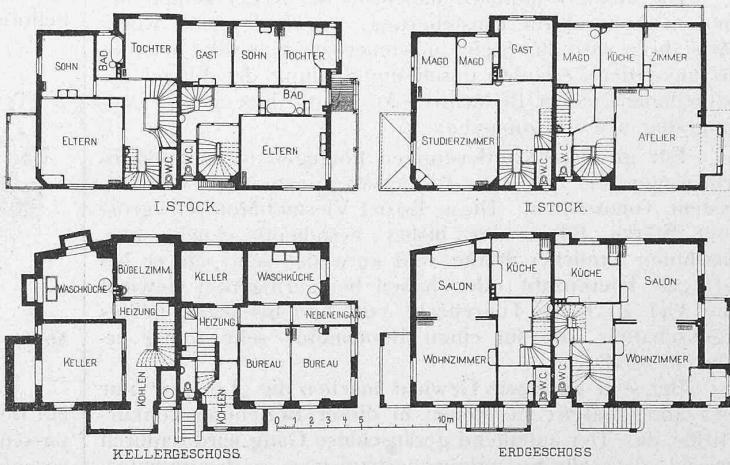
Doppelvilla an der Klosbachstrasse (Nr. 134, 136). — Grundrisse. — 1 : 400.
